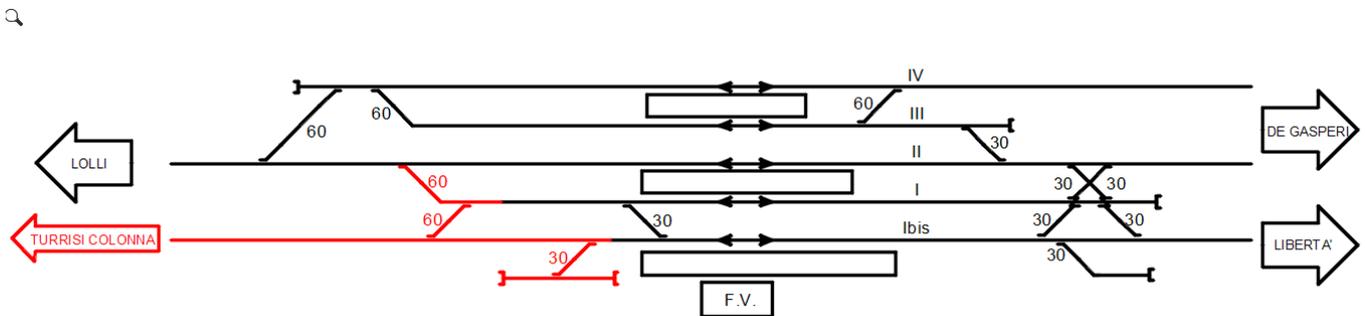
Layout funzionale delle modifiche di progetto - Stazione di Notarbartolo
